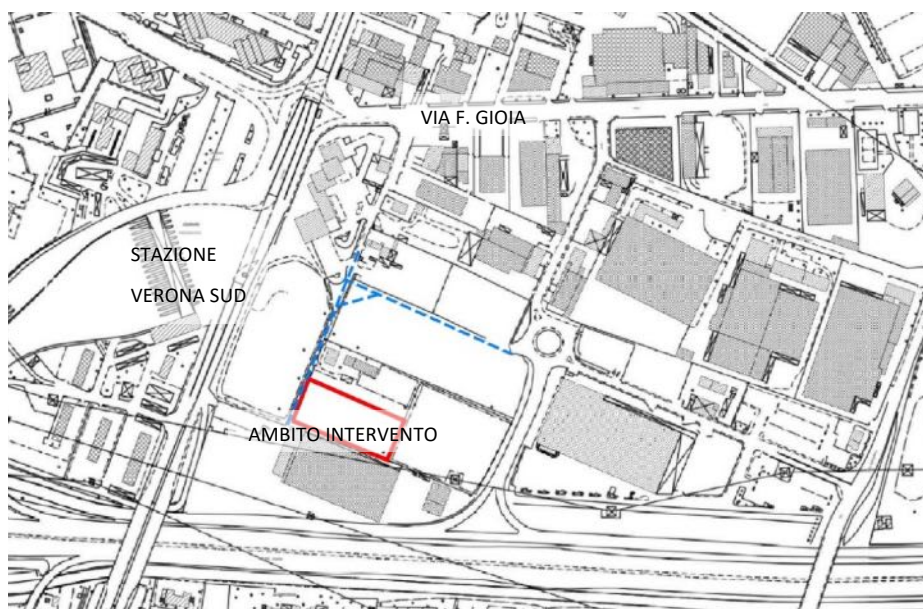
Stralcio planimetrico della corografia di intervento (in blu la nuova viabilità)
